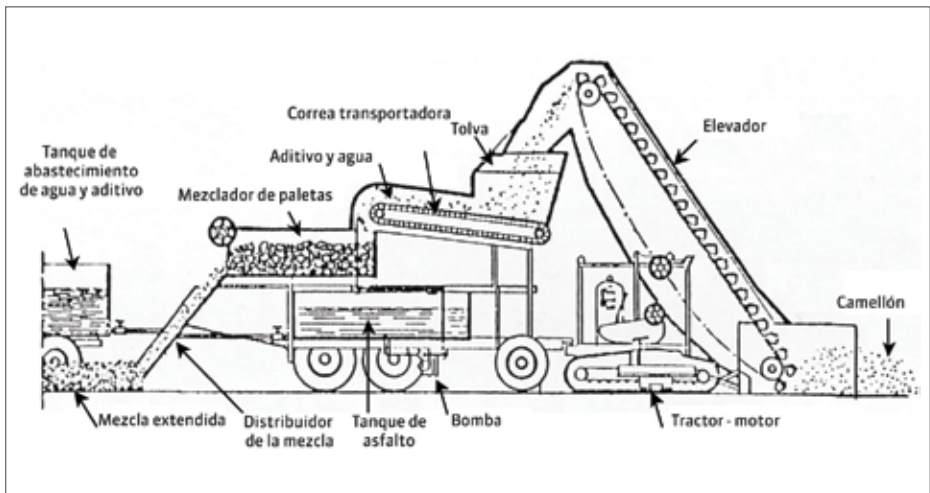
Planta mezcladora de tránsito tipo de elevación
